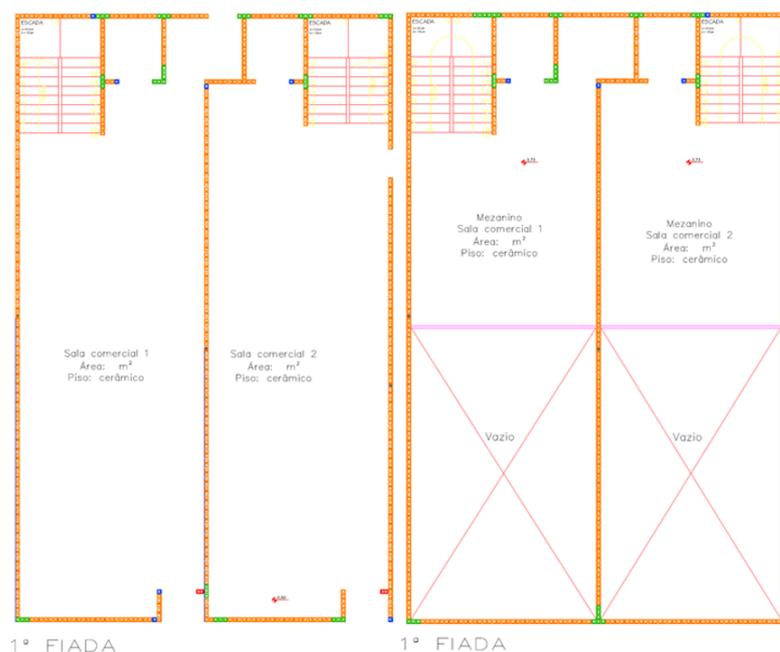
Planta baixa projeto original em concreto pré-moldado
